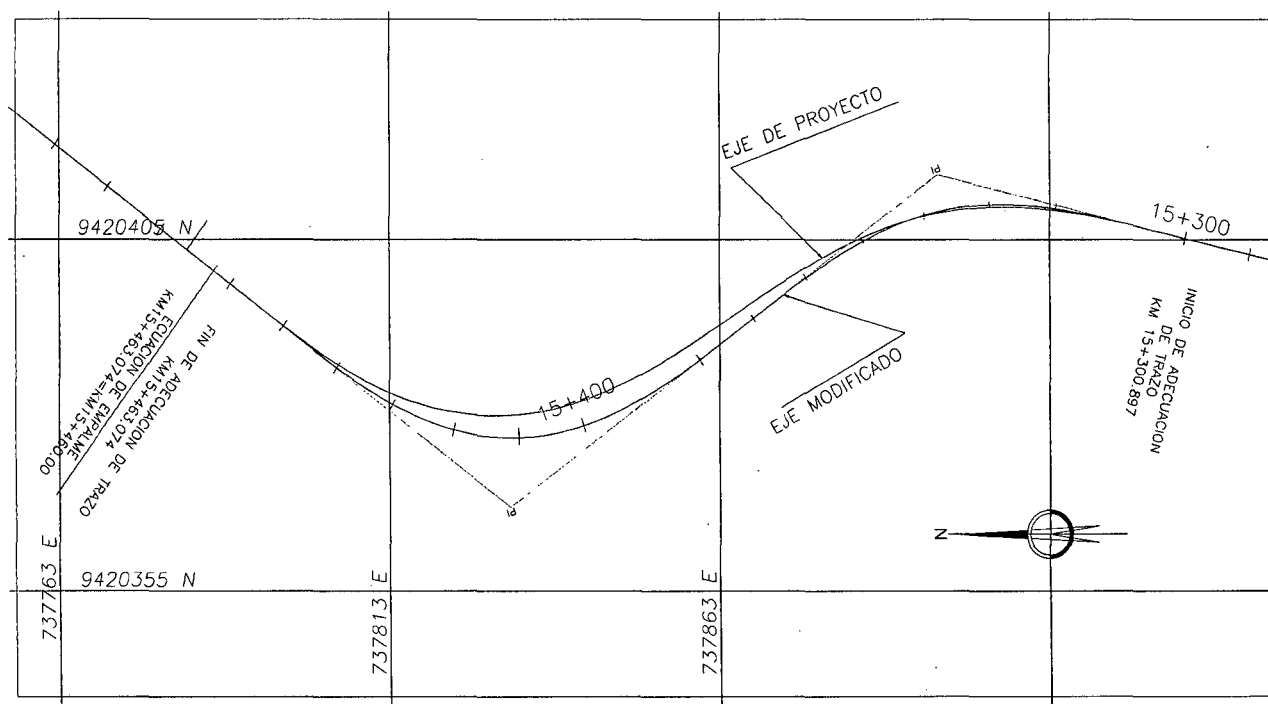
Plano en planta de la comparación del eje del proyecto y el replanteado de la variante 02.
